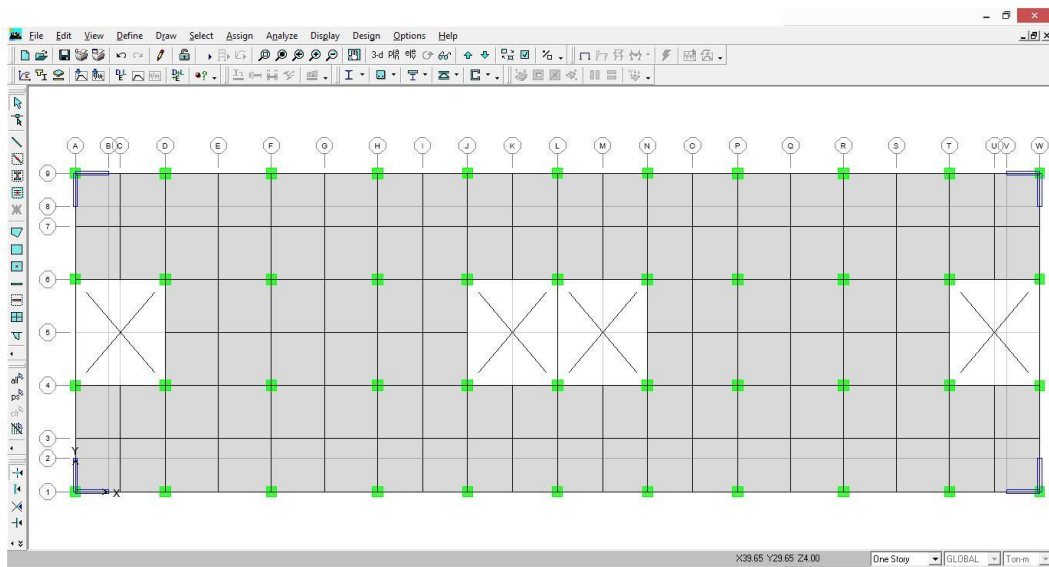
Denah Tampak Samping Arah y Struktur *Shearwall
